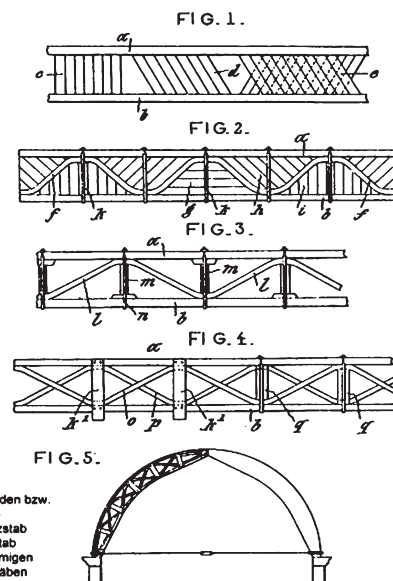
Fachwerkträgern mit geraden bzw. schrägen Aussteifungen
